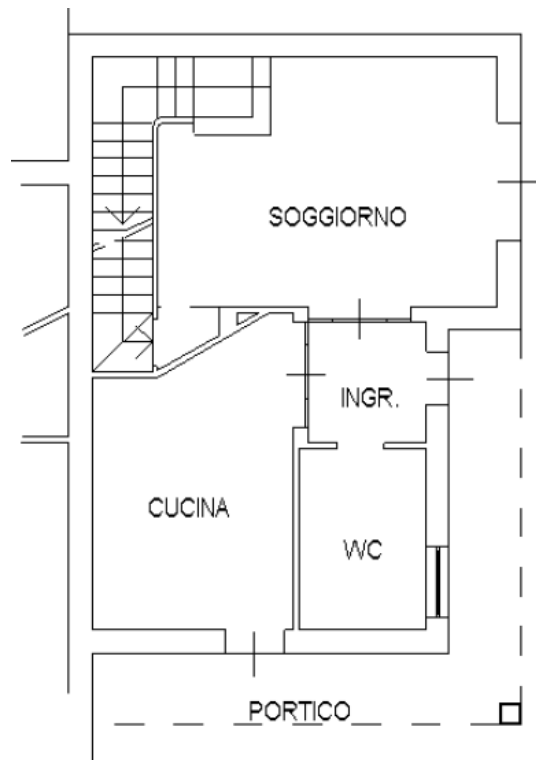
Estratto della planimetria catastale – sub. 2, p.t.
